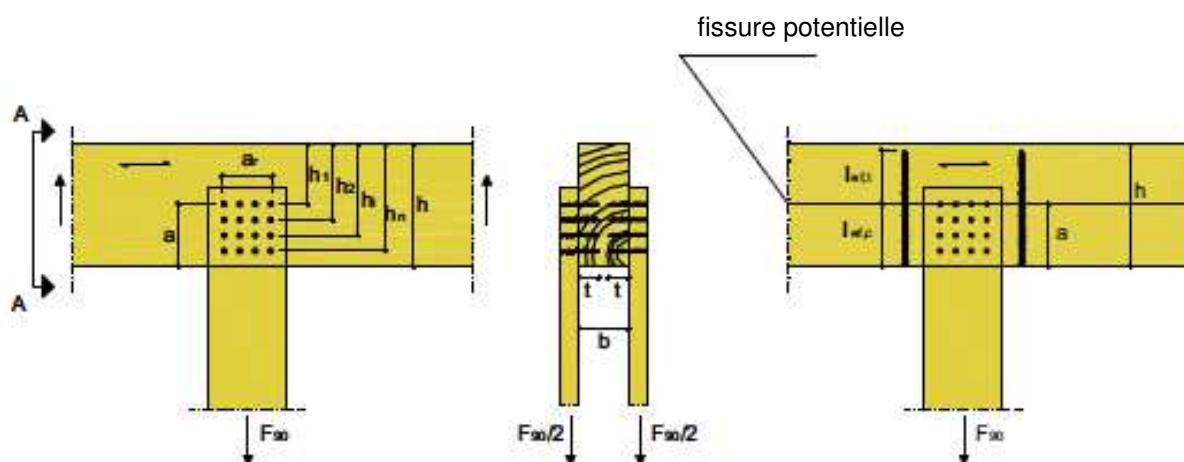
,1 : Exemple de renforcement d'un raccord transversal
